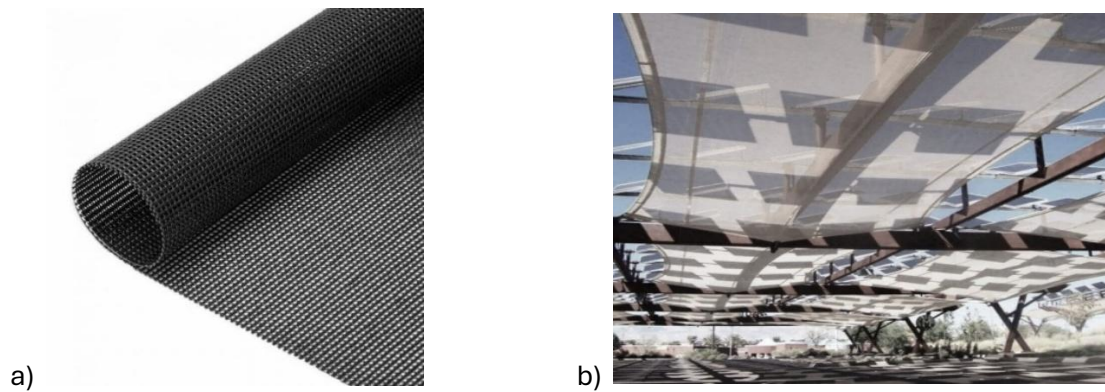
Textiles techniques utilisés a) toile PVC enduite b) application architecturale.
